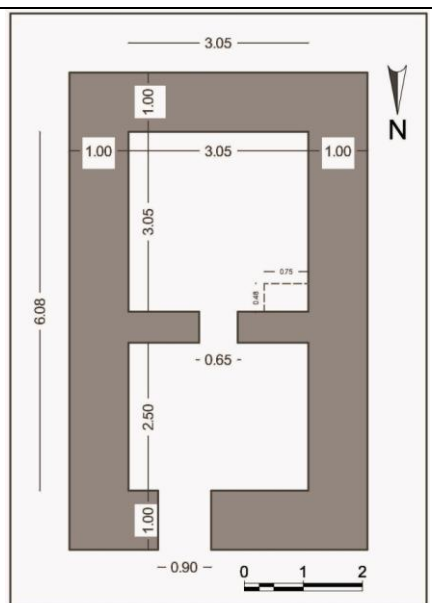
أطم (حصن) اللحياني: مسقط أفقي
